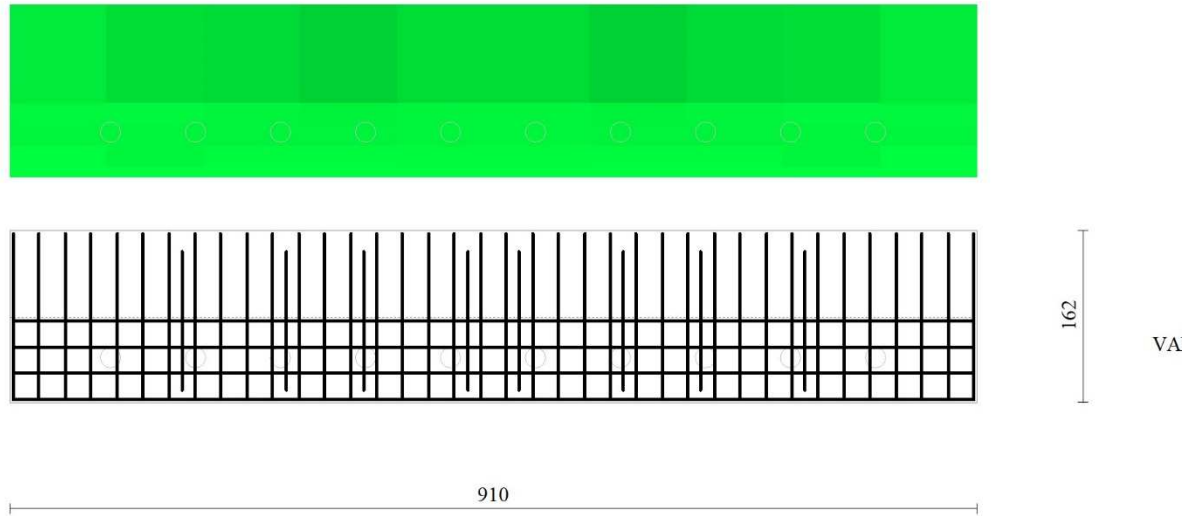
Piastra fondazione dir. Y (Inviluppo)
